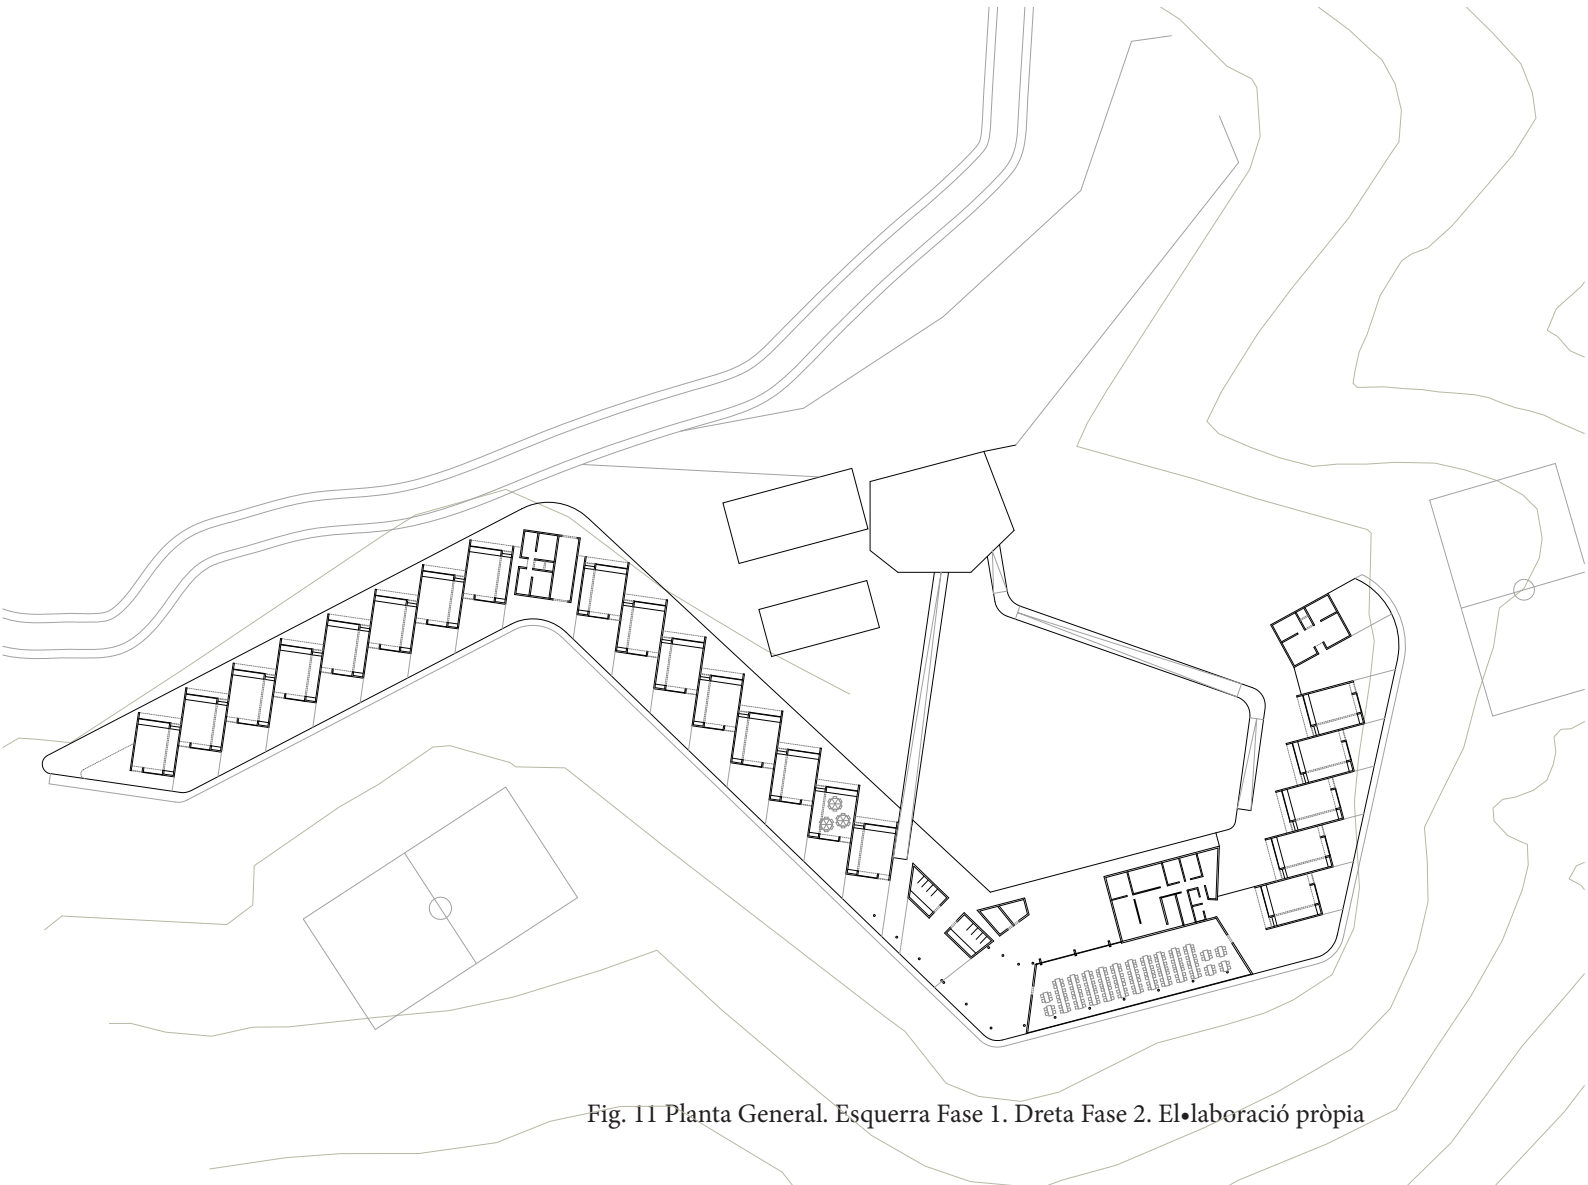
Planta General. Esquerra Fase 1. Dreta Fase 2. El•laboració pròpia
